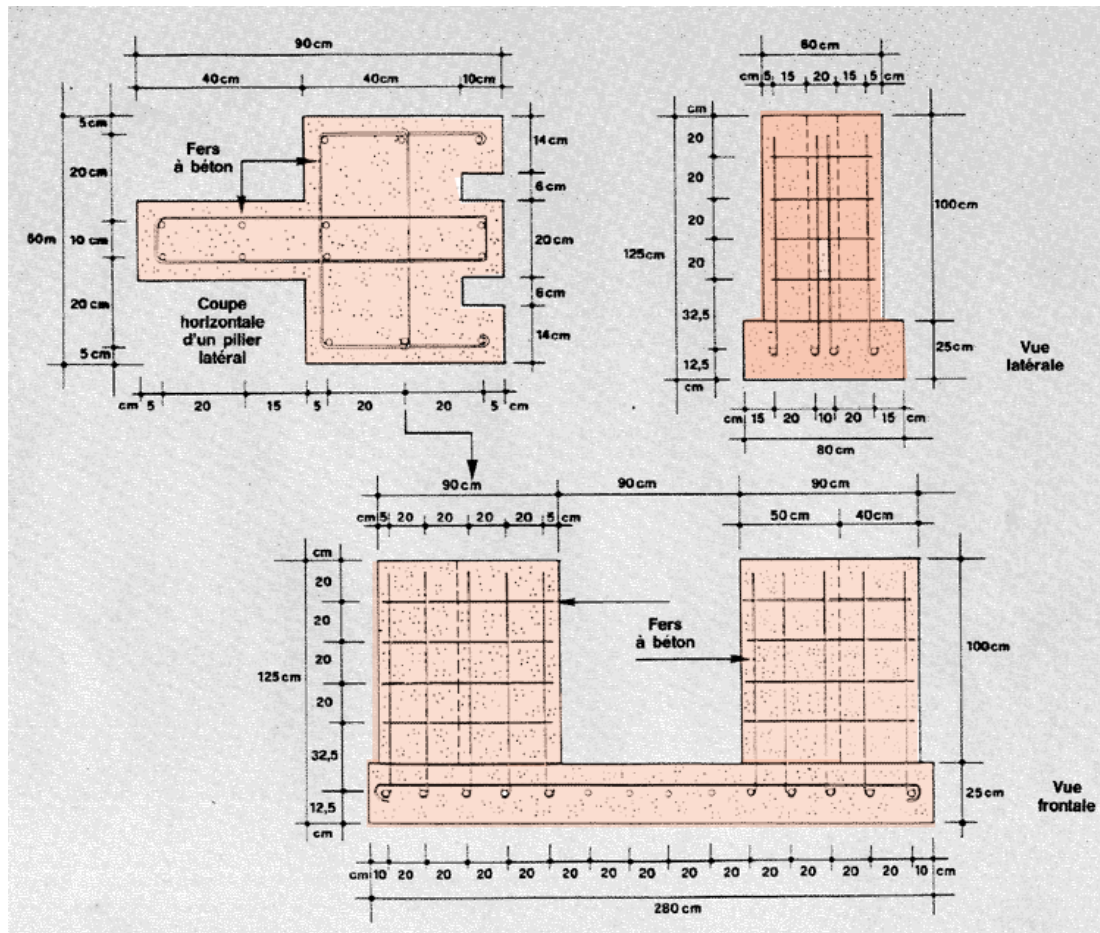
Placement de l'armature en fers à béton pour un barrage à deux piliers
